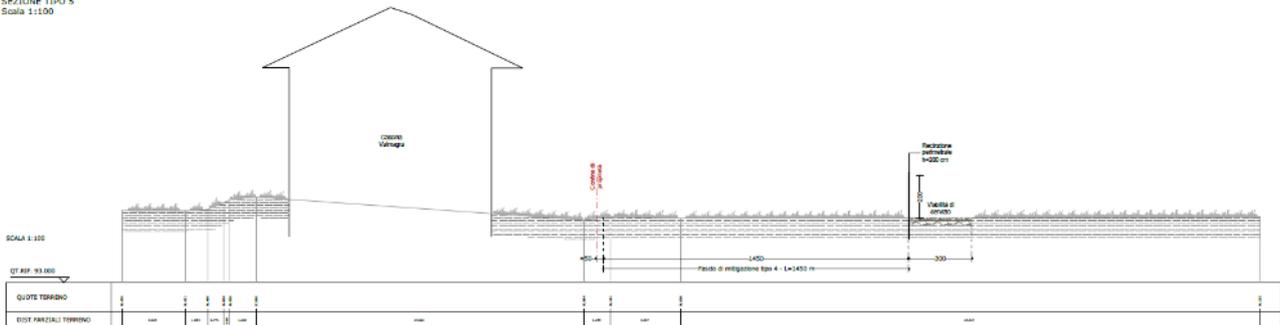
Sezioni di progetto con viabilità perimetrale (da Tav. C06\_00 di progetto).
